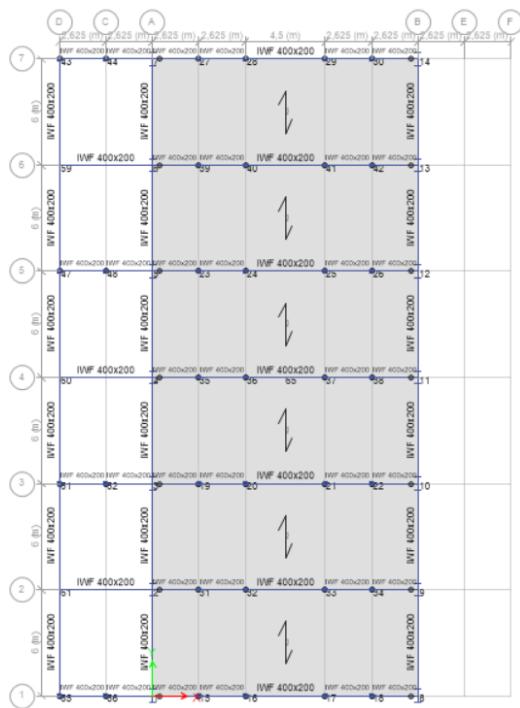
1 Denah Lantai 1 untuk Model Lebar Vierendeel panel
